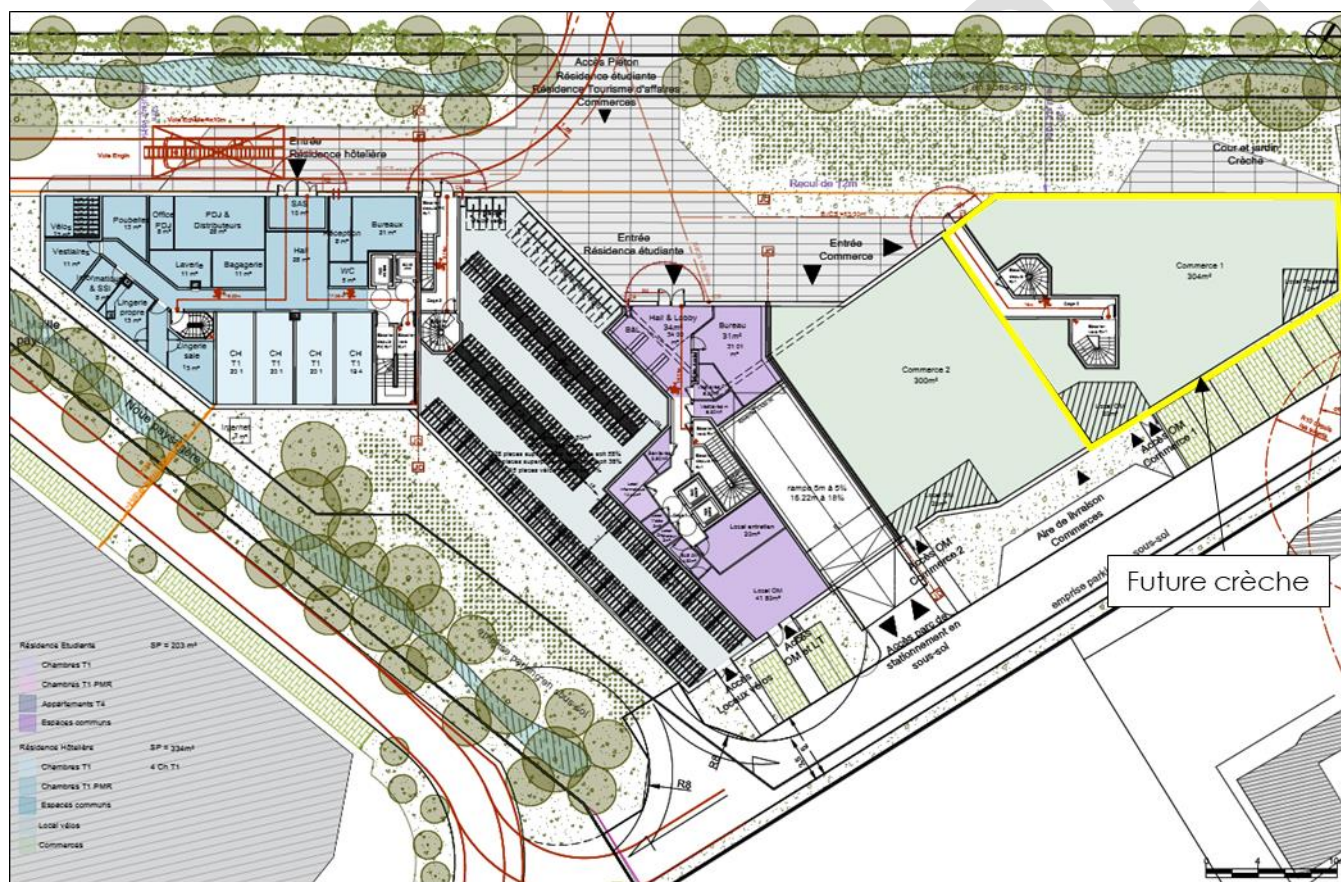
Plan de masse du projet (Source : Plan de masse-RdC – COGÉDIM – 20/03/2024)
